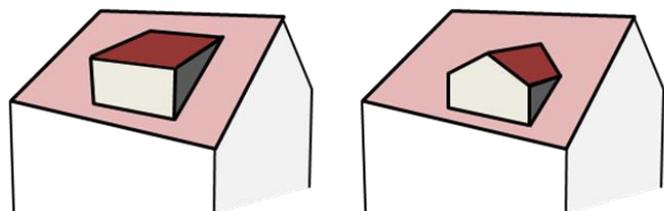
Abmessungen / Abstände zulässiger Dachgauben (Bsp.: Sattelgaube)
